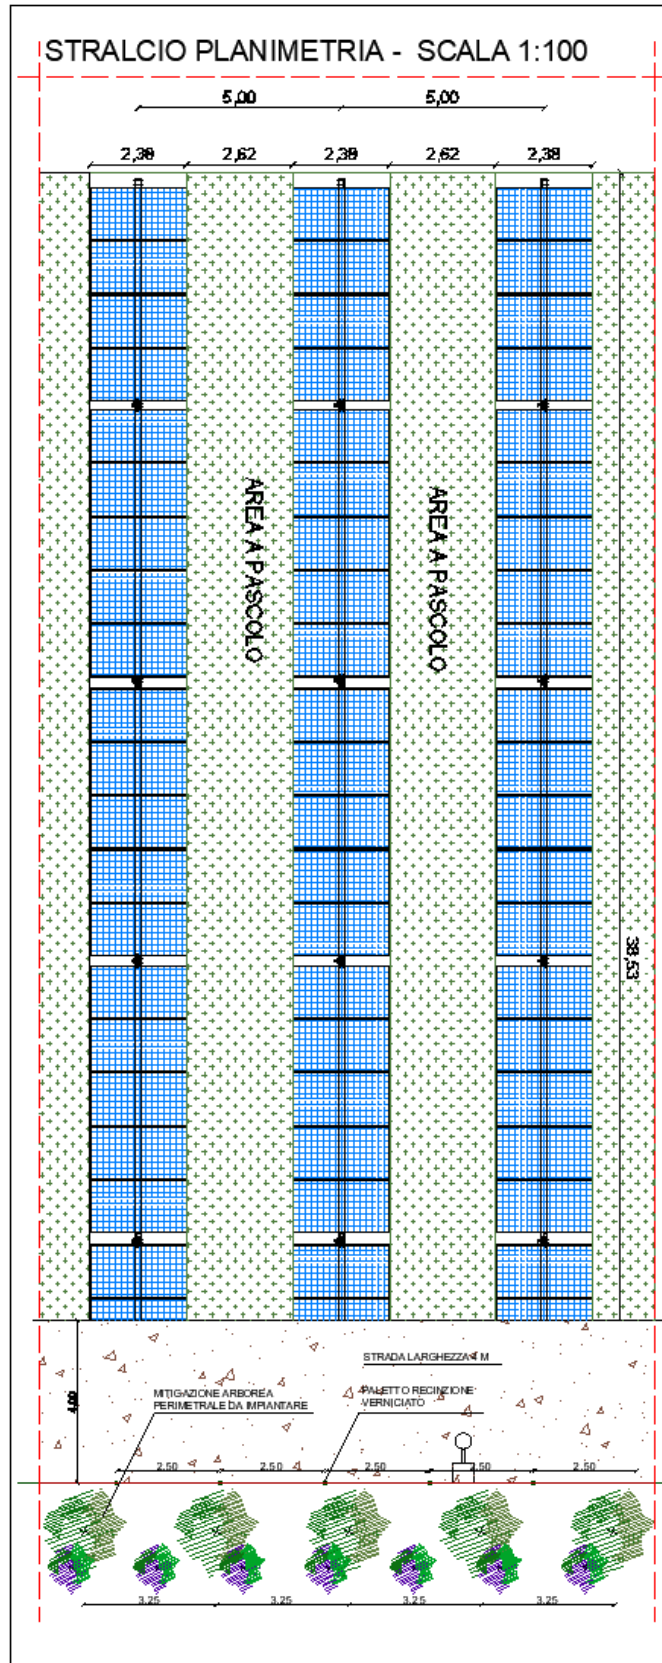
Layout filari di coltivazione, mitigazione perimetrale piantumata a corbezzolo
